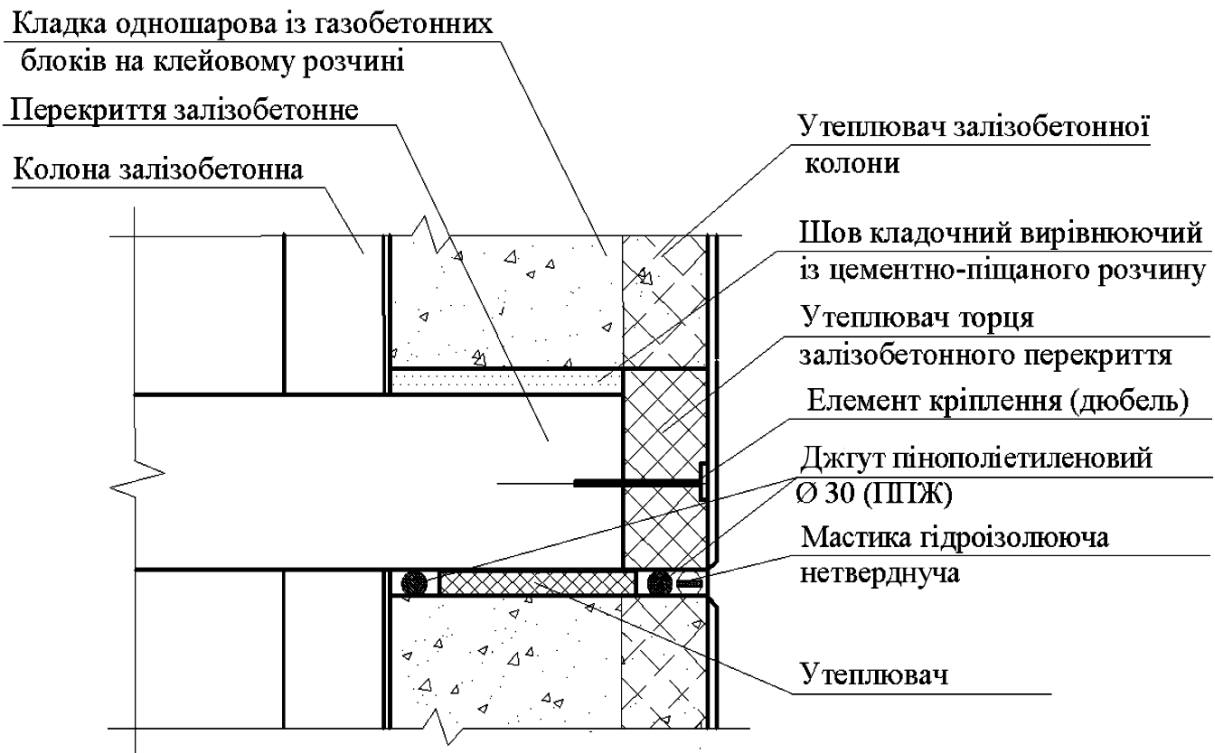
Конструктивне рішення влаштування вузла примикання стіни із газобетонних блоків до перекриття
